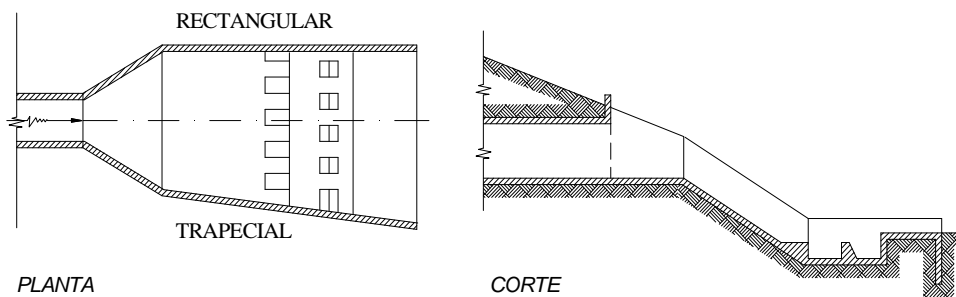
TERMINAL DE ALCANTARILLA CON RAPIDO DE HORMIGON
